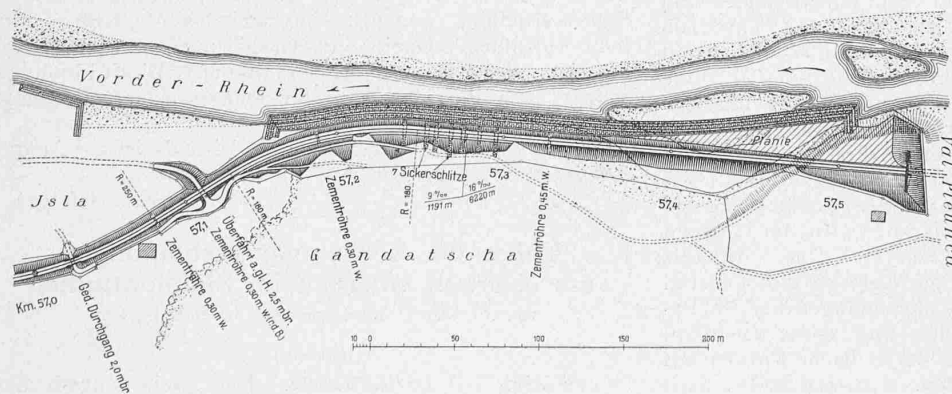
Rheinwahr und Bahnkörper bei Km. 57,0 bis 57,5. — Lageplan 1:4000.
